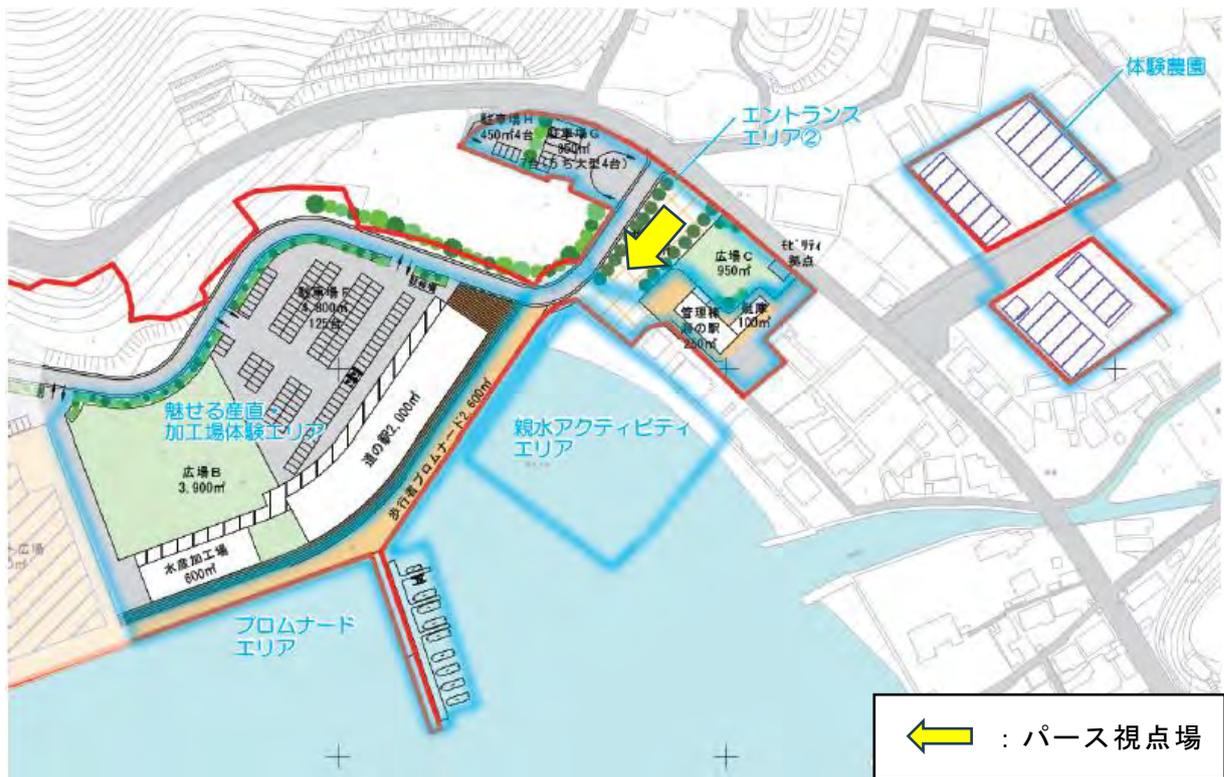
道の駅・海の駅ゾーンの平面図及び整備イメージ
